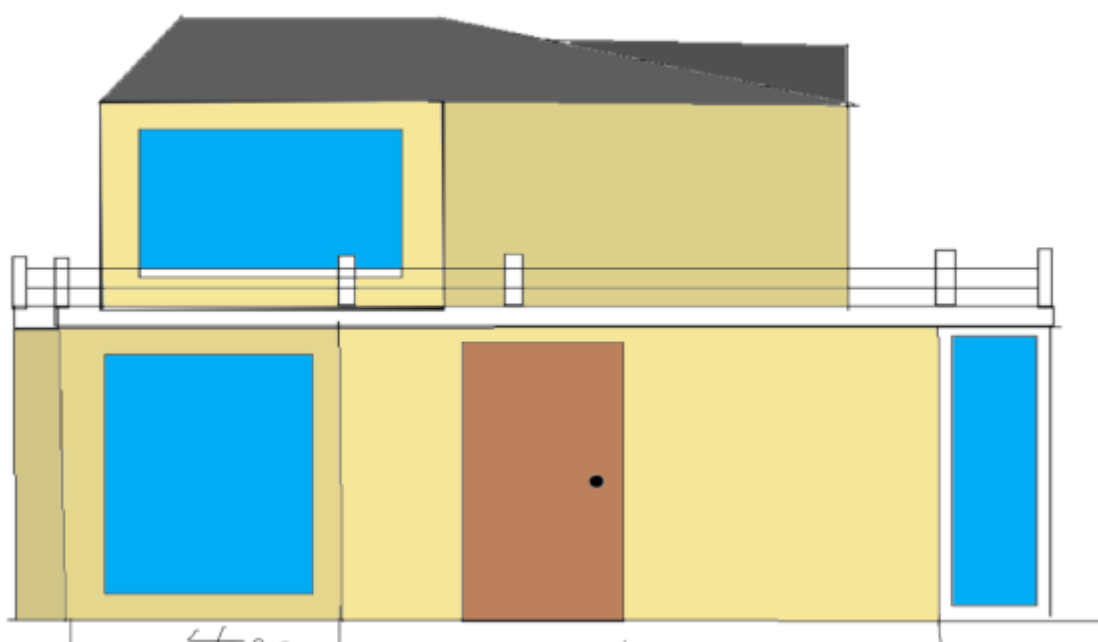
Решение фасадов жилого дома (ЮЖНЫЙ фасад)
